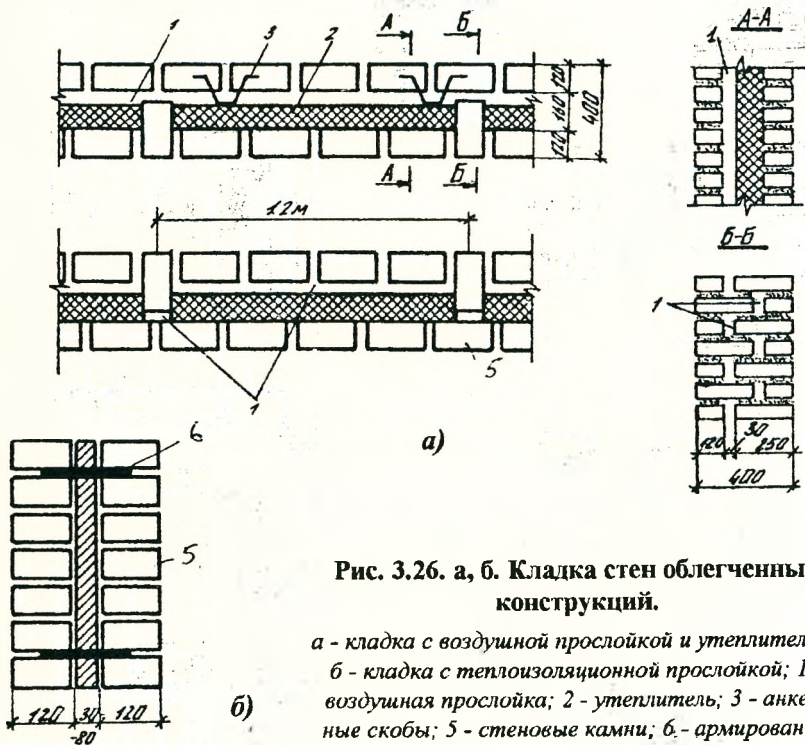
а, б. Кладка стен облегченных конструкций.
